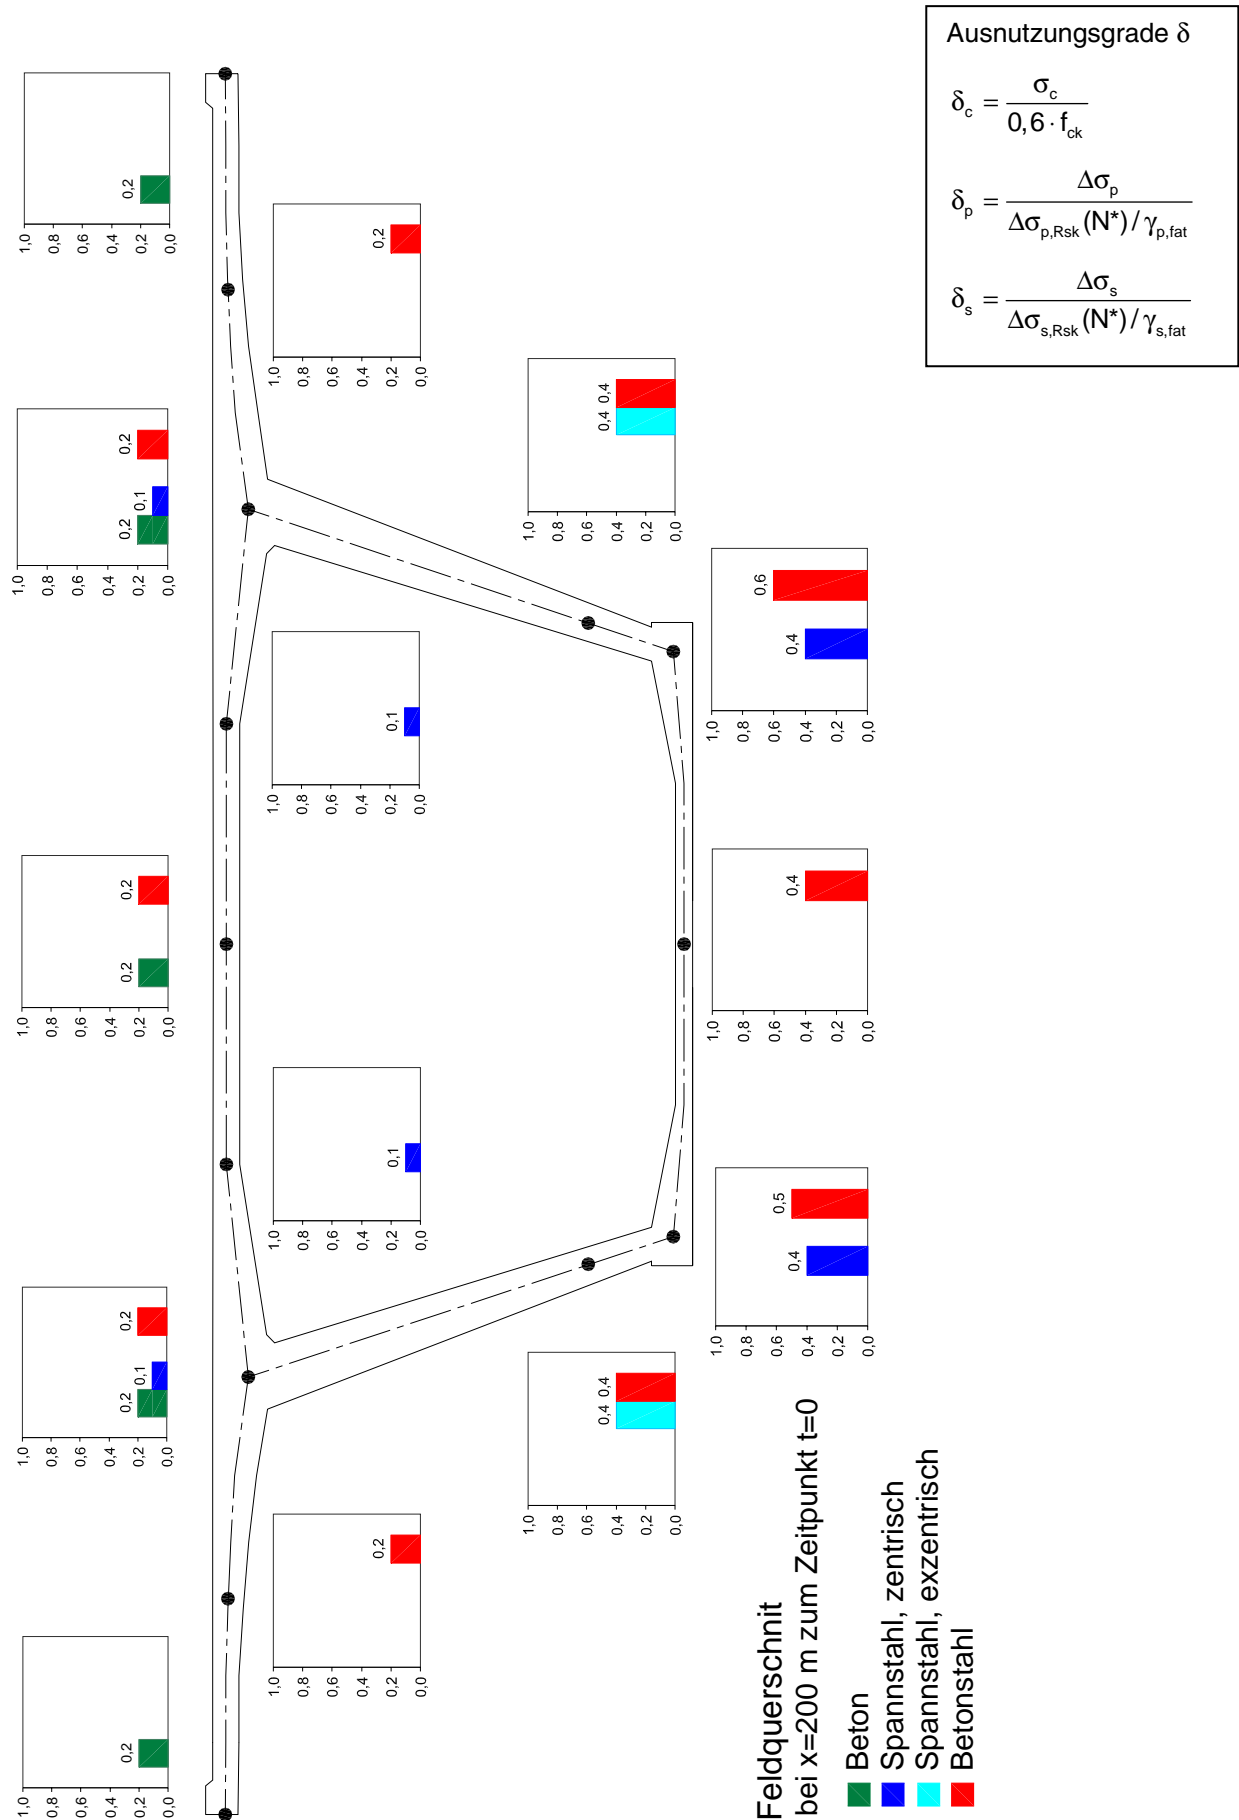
Ausnutzungsgrade des Betons δ_c , Spannstahls δ_p und Betonstahls δ_s
